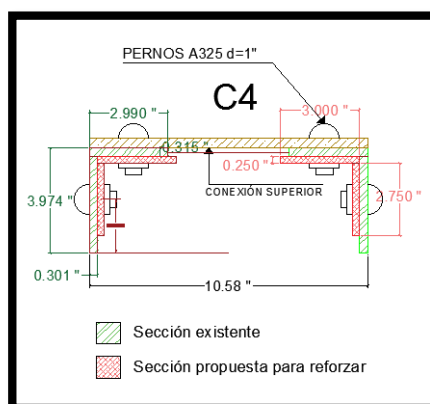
Secciones para reforzamiento de C4 – Compuesta. Arriostre
